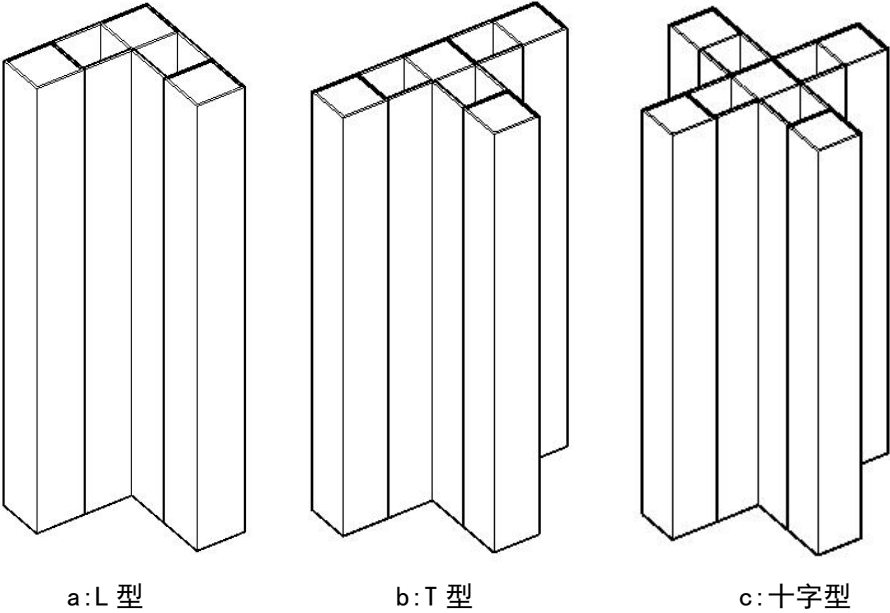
连续缀板式钢管混凝土组合柱示意图
